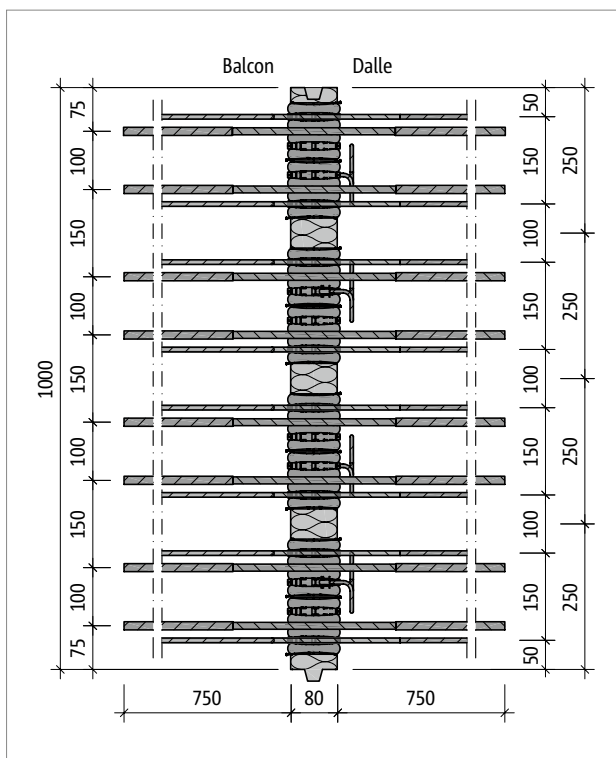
Schöck Isokorb® T type K-E-M8-V1 : plan de base du produit
